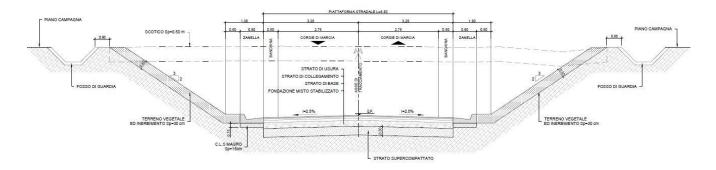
Dest. Particolare 6.5m - sezione tipo in trincea
